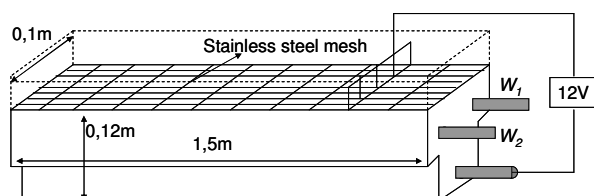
Esquema con las dimensiones de la viga en T pretensada, indicando las conexiones empleadas para el ensayo de penetración acelerada del ión Cl^- .
